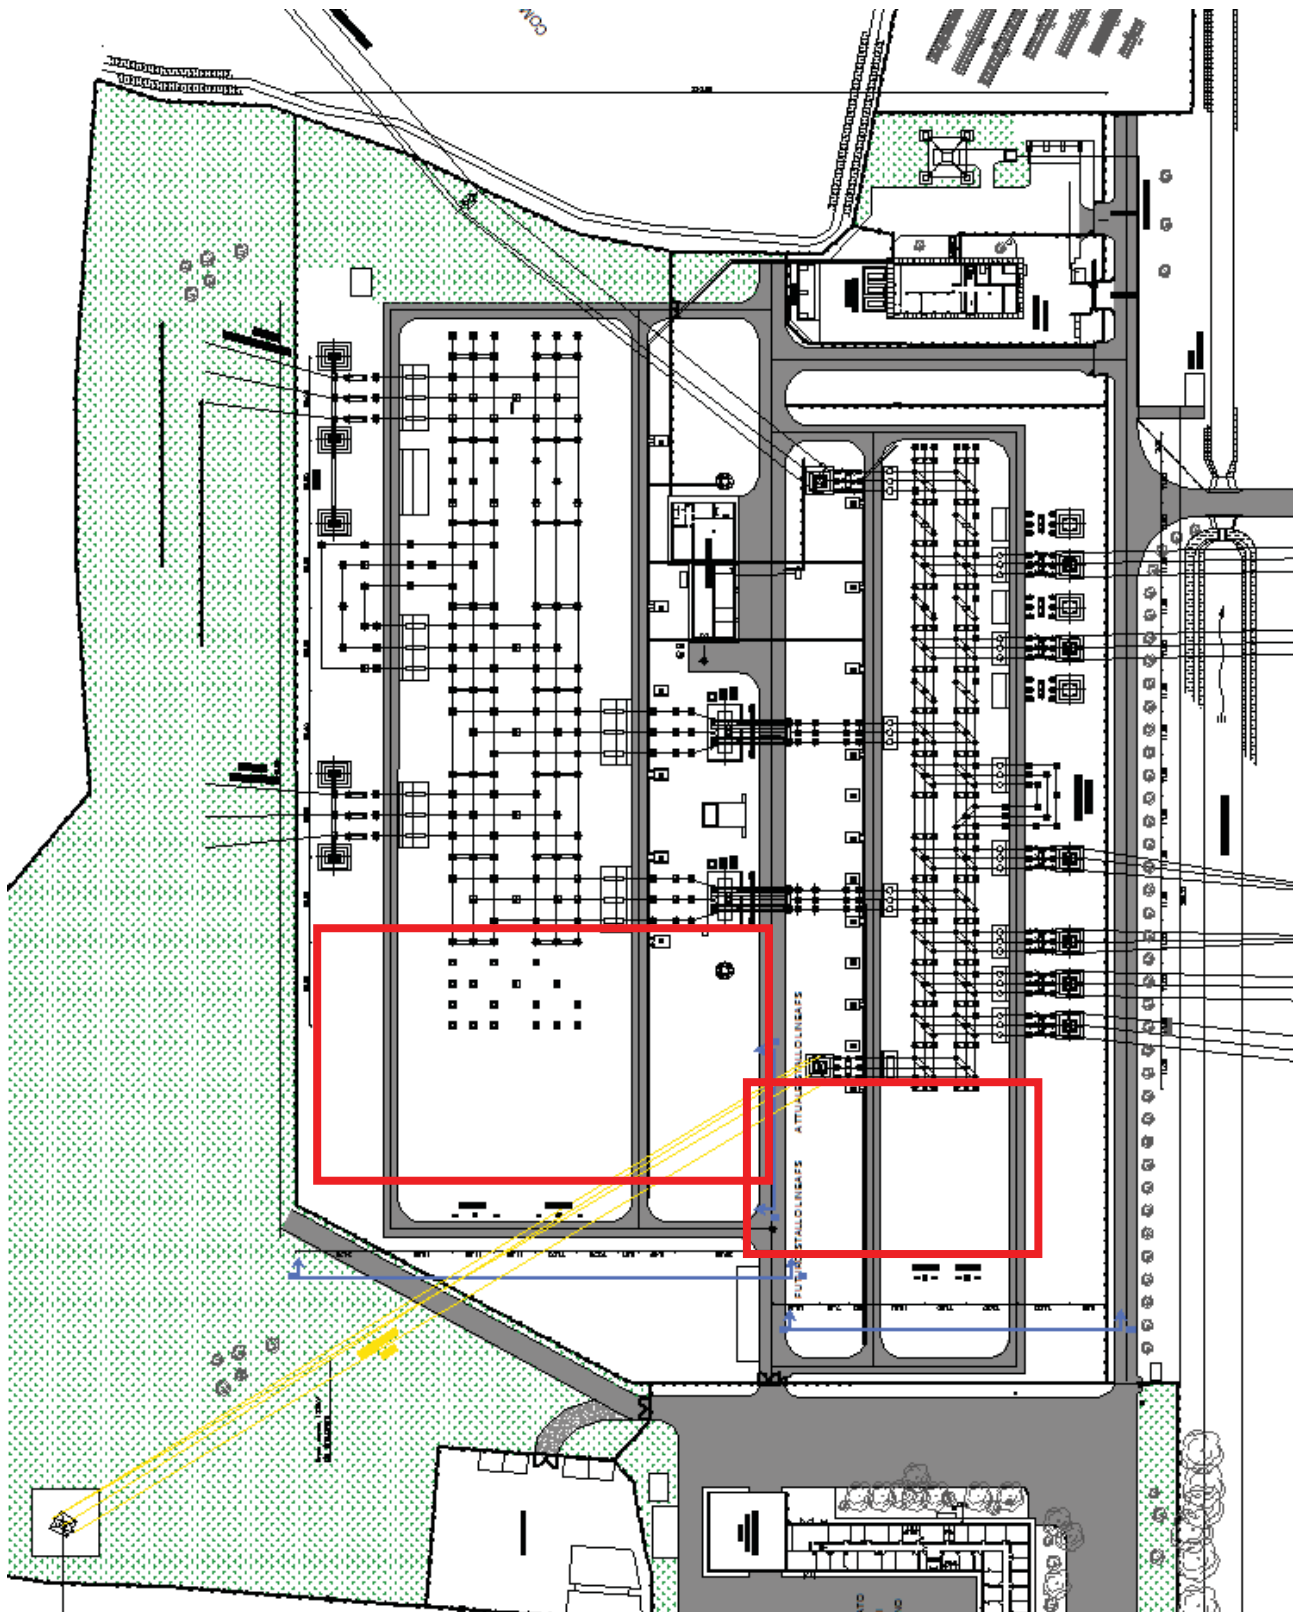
Planimetria stato di fatto con individuazione area di intervento
